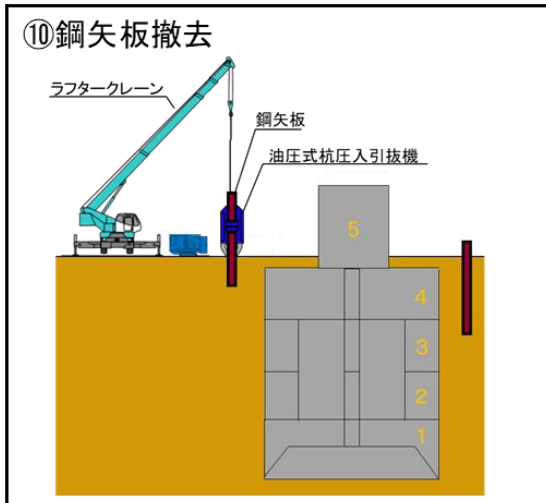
(4) 下部工 (ニューマチックケーソン基礎) の施工手順
